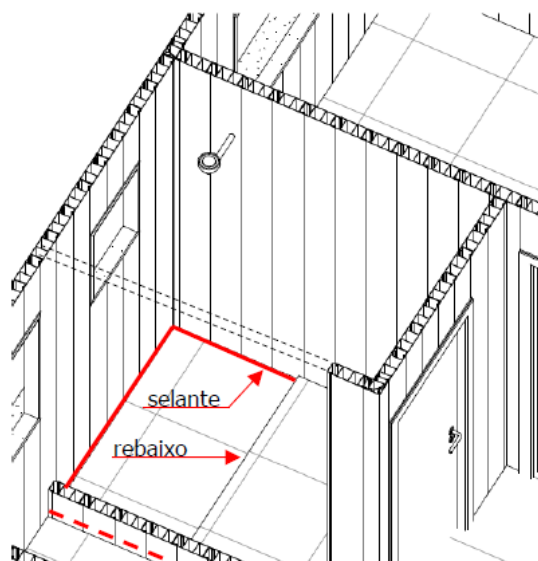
Ilustração da aplicação do cordão de selante monocomponente a base de poliuretano para impermeabilização da interface entre parede e piso na área do box do banheiro. (Sem escala).
